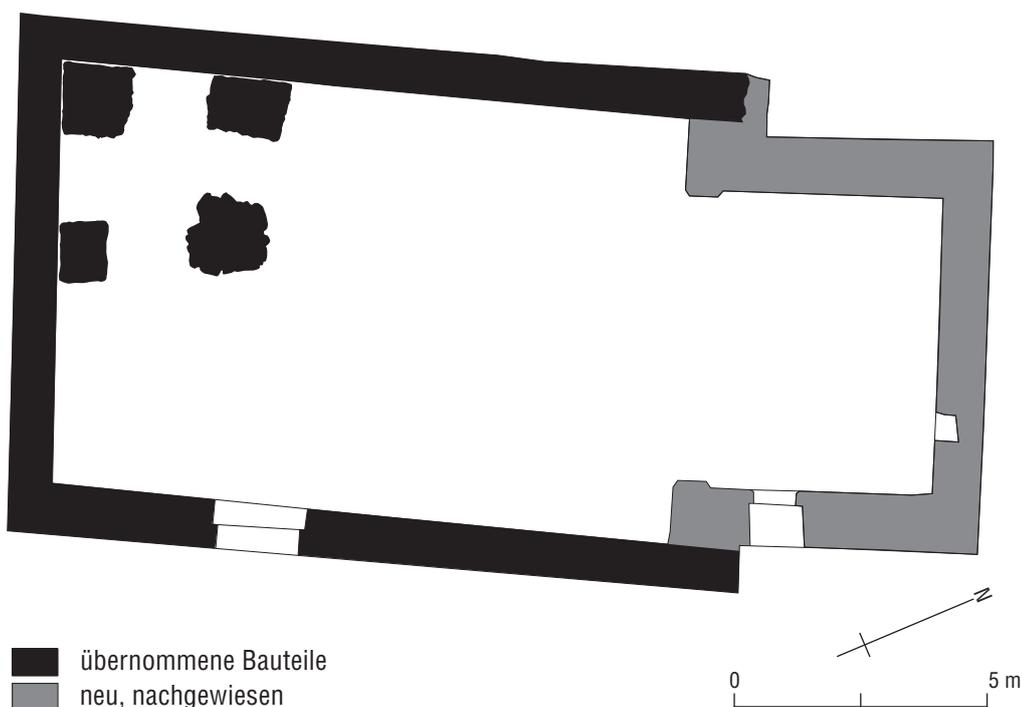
Rhäzüns, Sogn Gieri. 2019. Grundriss Bau V, erste Hälfte 13. Jahrhundert. Mst. 1:150.
